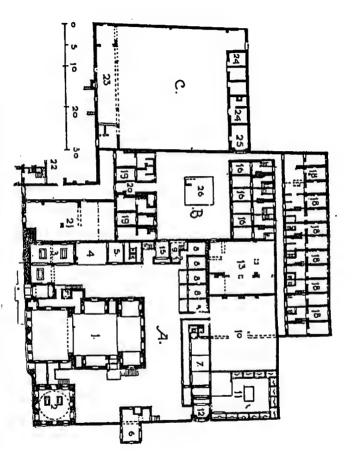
مسقط أفقى لقبة نصر الله عن هيئة الآثار
